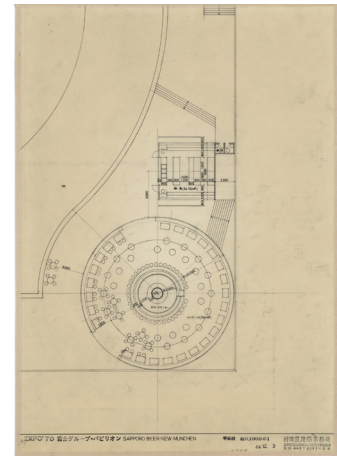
SAPPORO BEER NEW MUNCHEN 平面図 (7-13-44)
